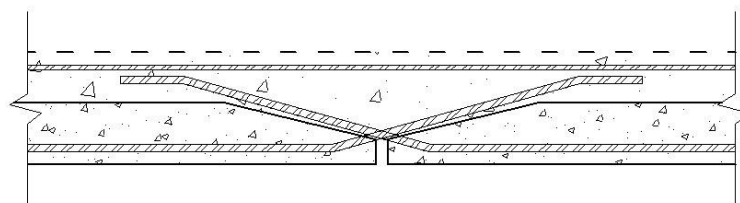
Ligação entre pré-lajes maciças através da colocação de armaduras transversais [45]
